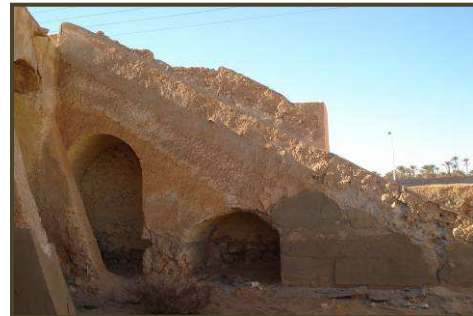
Escalier sur paillasse en bois. (Source : Ait Kadi.S, 2012)
